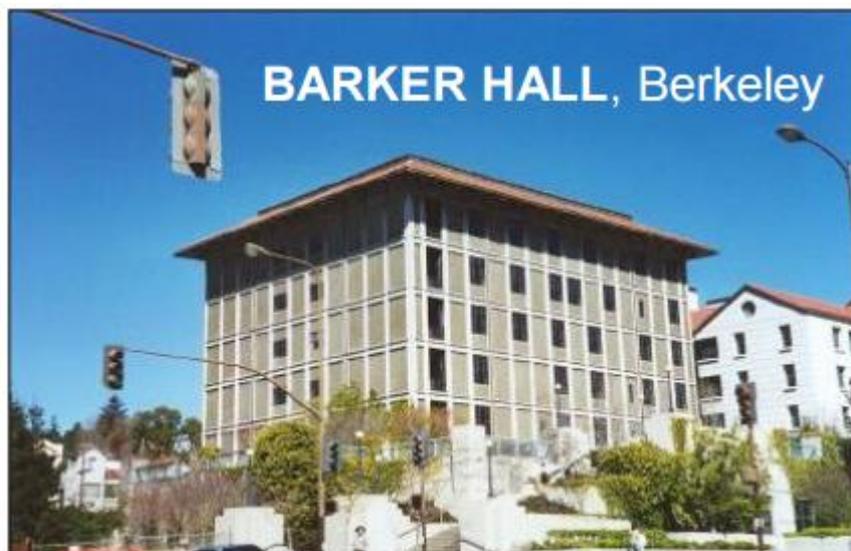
Edifício Barker Hall, Berkeley construído com Concreto com Alto teor de Cinzas Volantes HVFA 50 MPa – 56 dias 2,2 Kg CO₂ /MPa. Fonte: Mehta, P.K.; ACI Concrete International, Fevereiro/2009 Otimização das Estruturas de Concreto Armado
